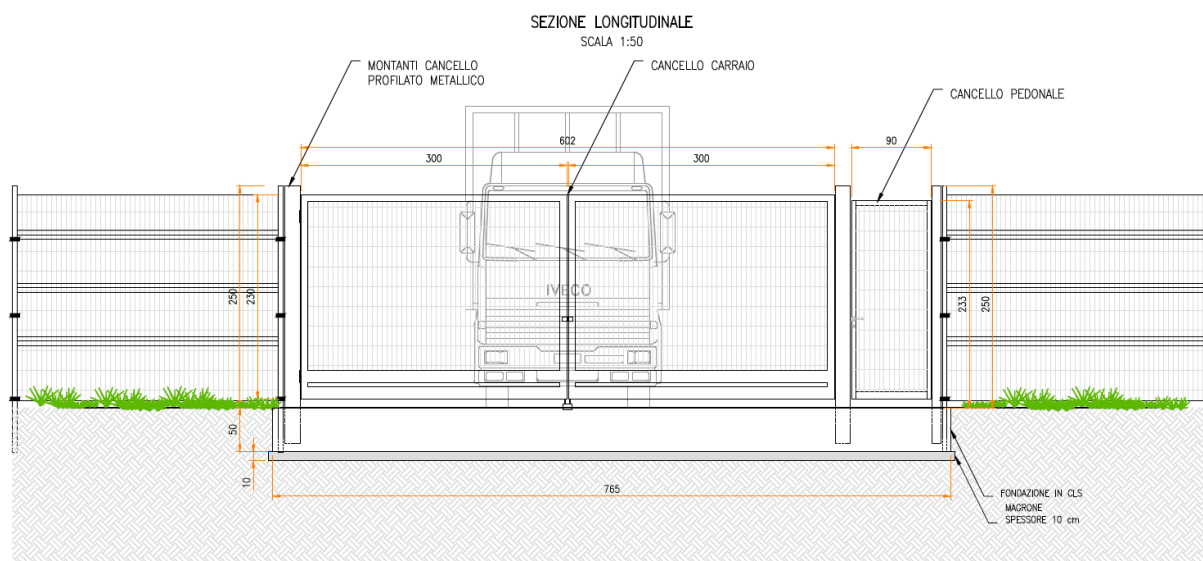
Sezione longitudinale accesso carraio e pedonale
